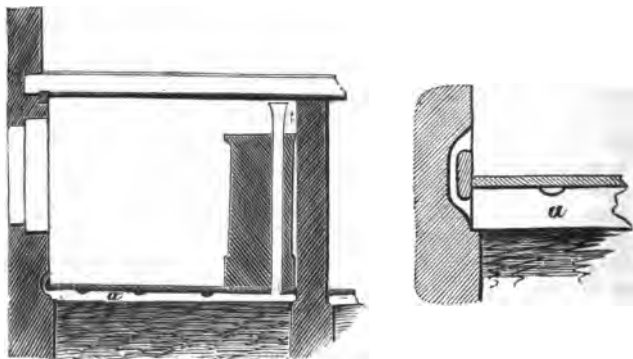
Nicht unterstellter Fußboden mit Luftzügen.
